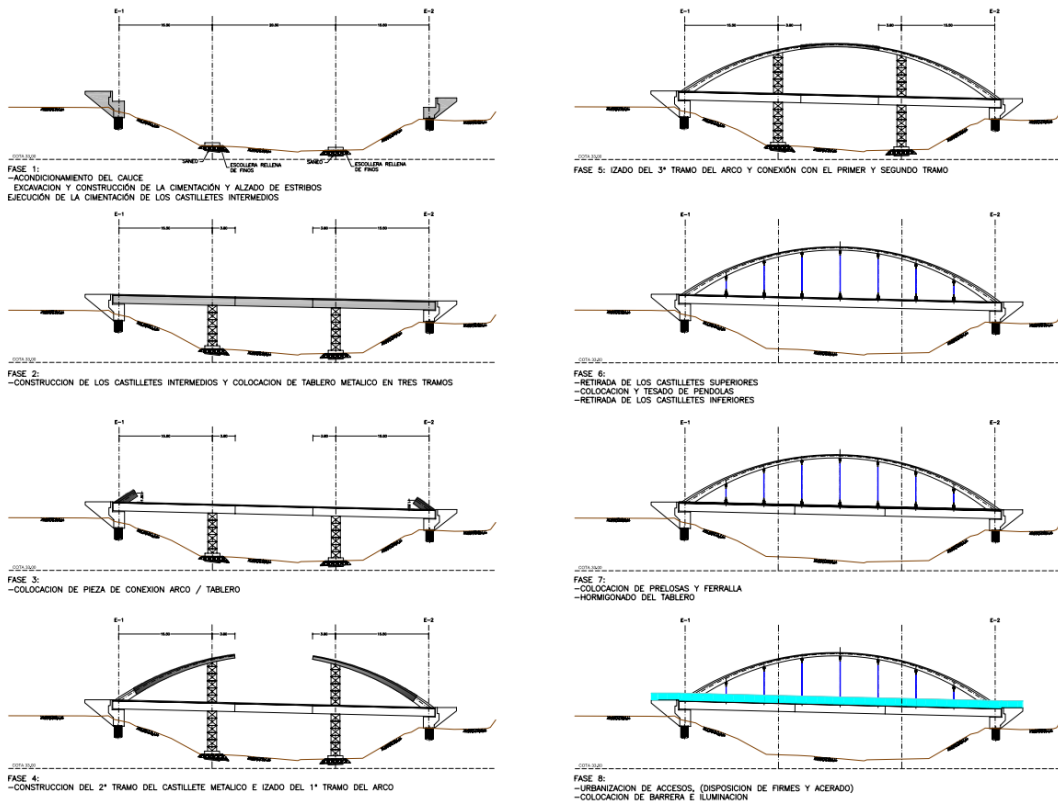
Plano del proceso constructivo (Proyecto del puente)
